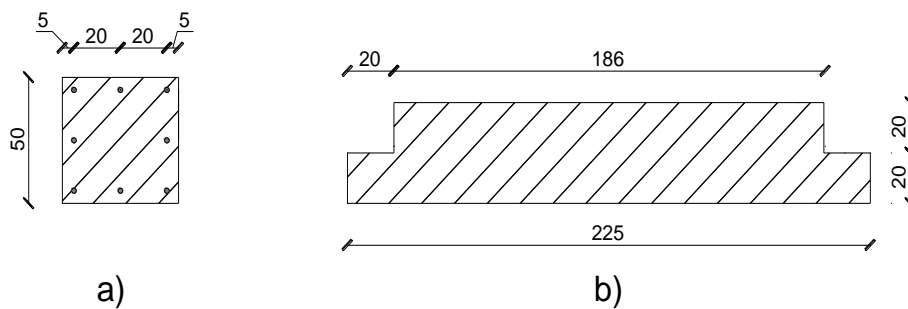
a)sezione corrente del pilastro multipiano b)sezione del capitello
